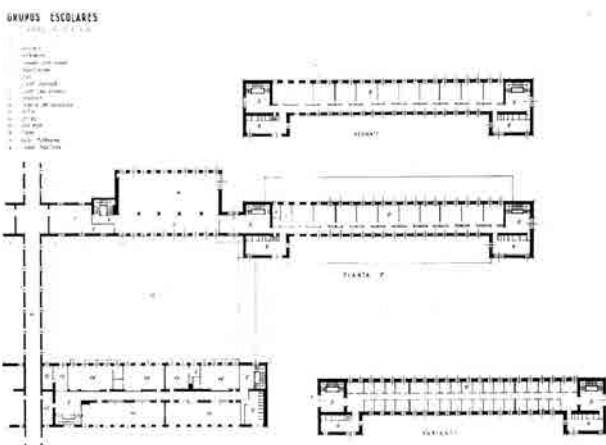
y Fig. 37 Grupos escolares de la Universidad Laboral de Sevilla. Planta primera y variantes de la planta tipo de dormitorios (izquierda) y planta baja (derecha).
